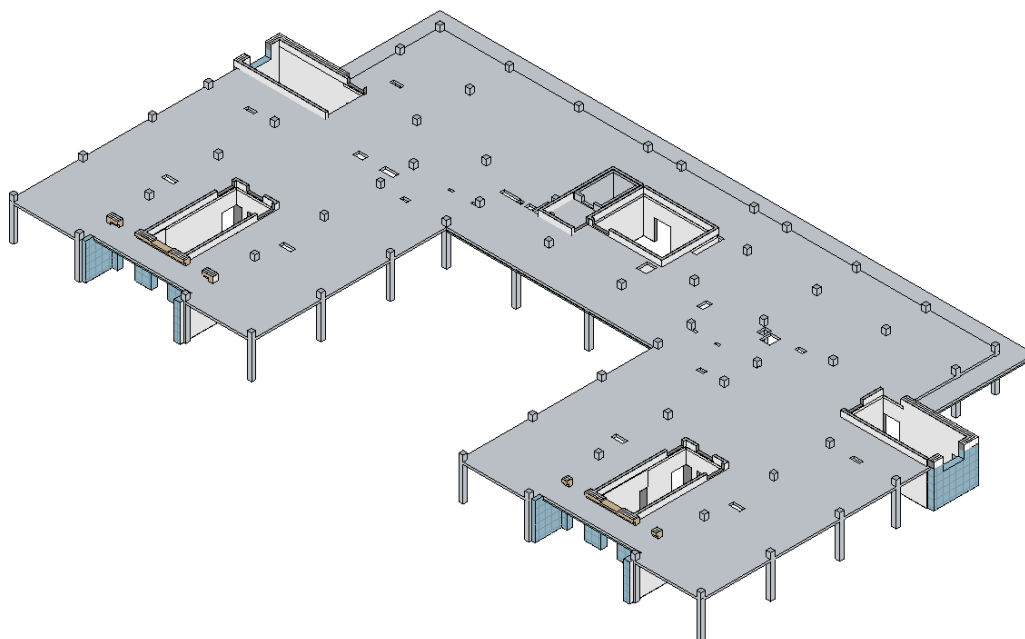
Схема плиты перекрытия над 1 этажом
